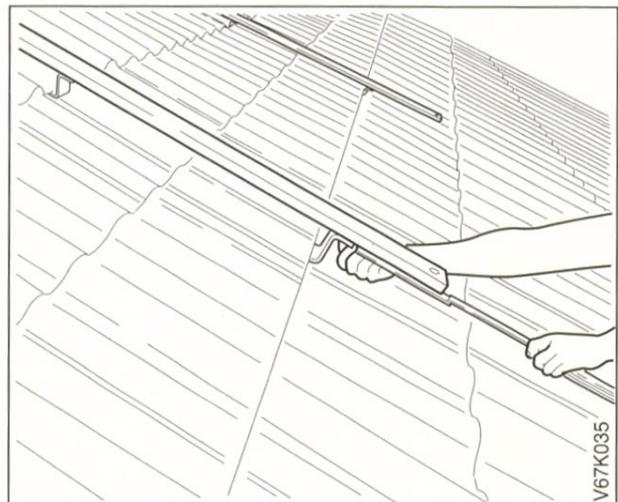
Montageschienen mit Hammerkopfschrauben (M10x30) auf gleicher Höhe an Sparrenankern festschrauben.
